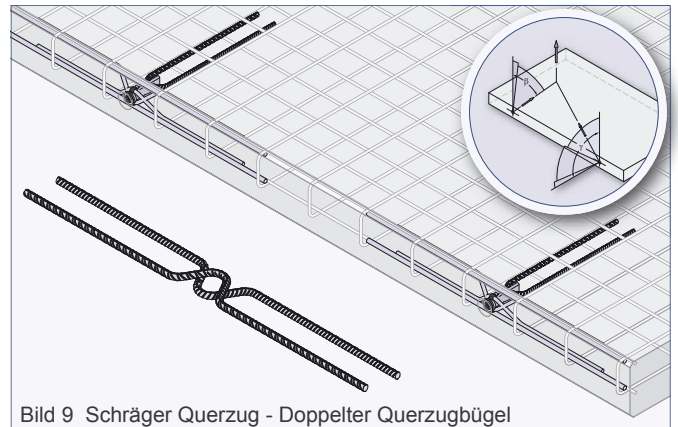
Schräger Querzug - Doppelter Querzugbügel
